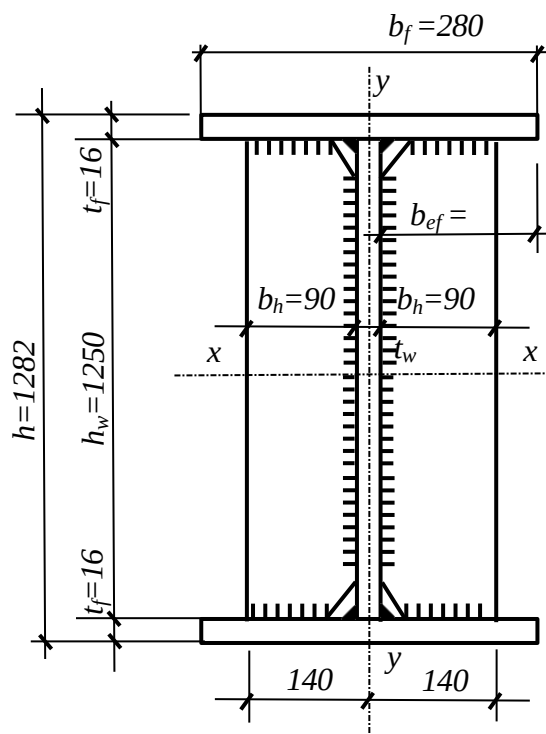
Поперечное сечение стропильной балки покрытия с гибкой стенкой
